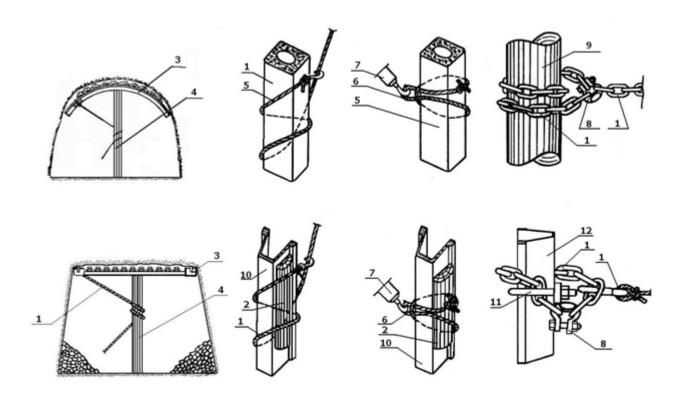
Соединение строп с элементами крепи Условные обозначения: 1 — отрезок каната цепи 18х64 (строп); 2 — подложка деревянная; 3 — верхняк; 4 — усиливающая крепь; 5 — стойка железобетонная; 6 — строп кольцевой; 7 — лебедка ручная; 8 — полукольцо цепи; 9 — стойка деревянная; 10 — стойка стальная; 11 — хомут М16; 12 — стойка, верхняк стальной арочной крепи
